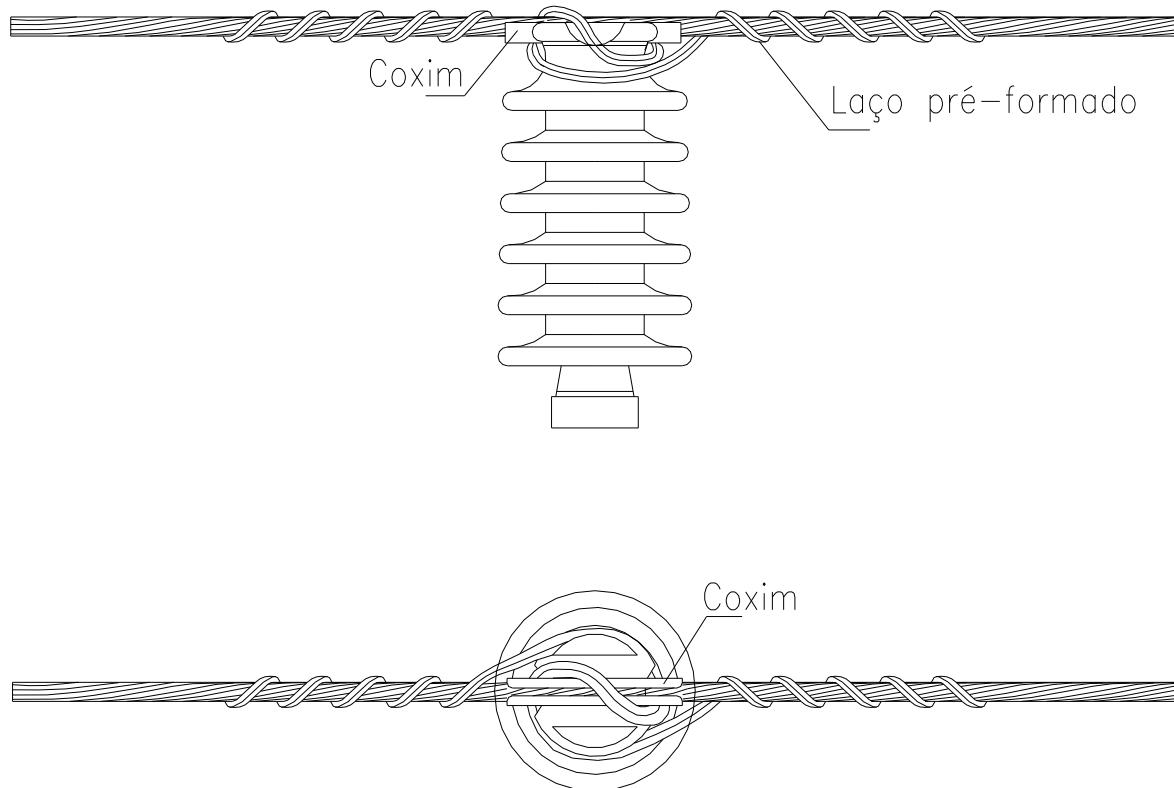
Amarrações e ligações – Primário – Amarração simples de topo
